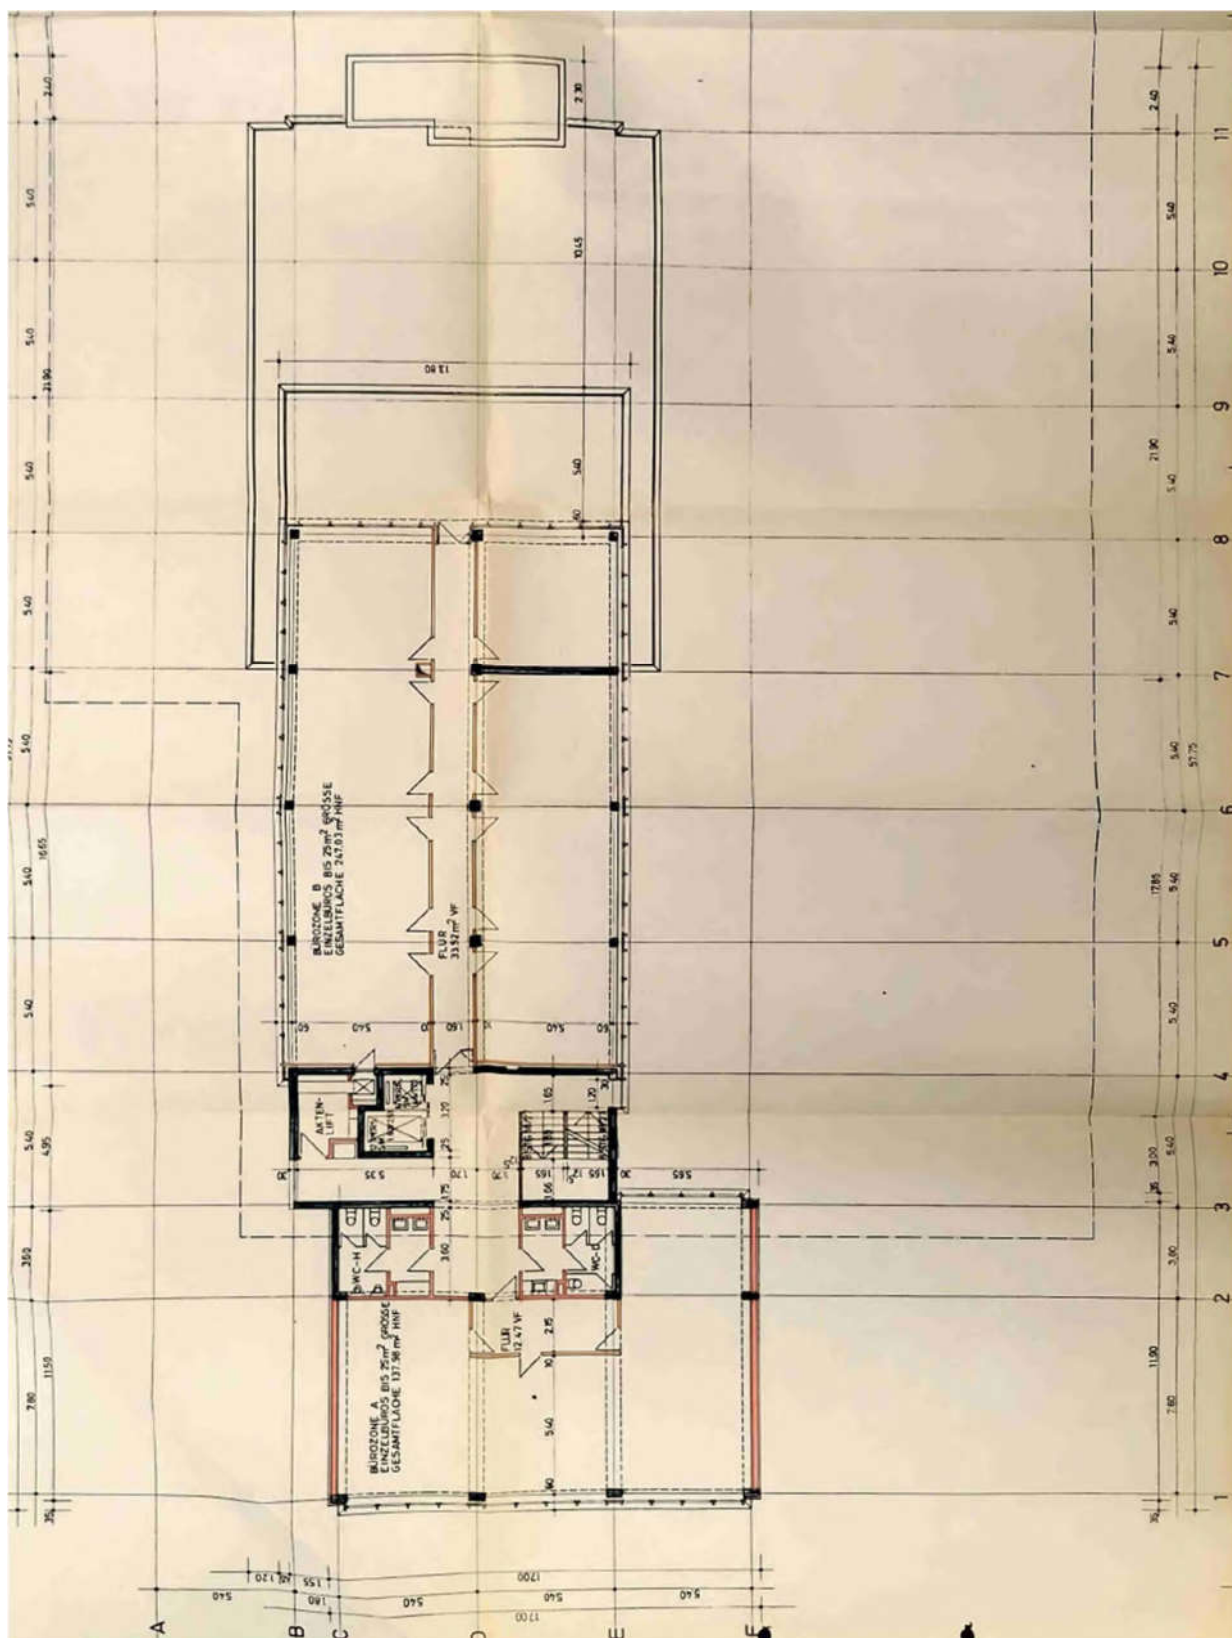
Grundriss 5. Obergeschoss
